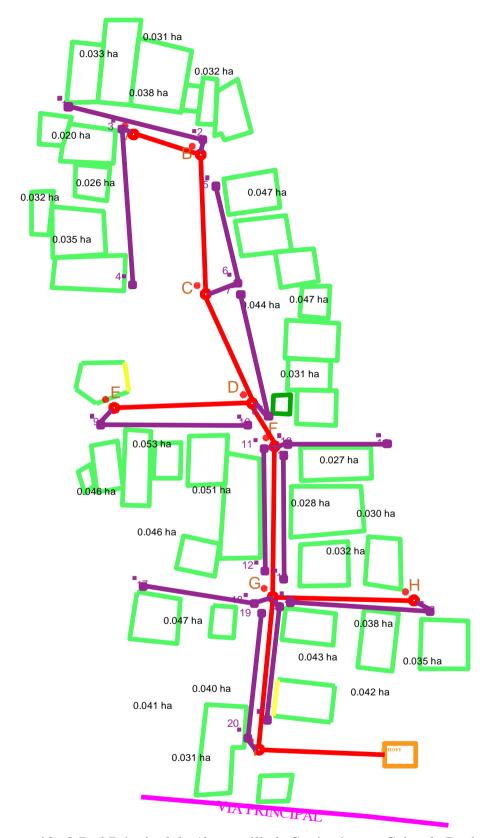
Red Principal de Alcantarillado Sanitario con Cajas de Registro Fuente: Autores
